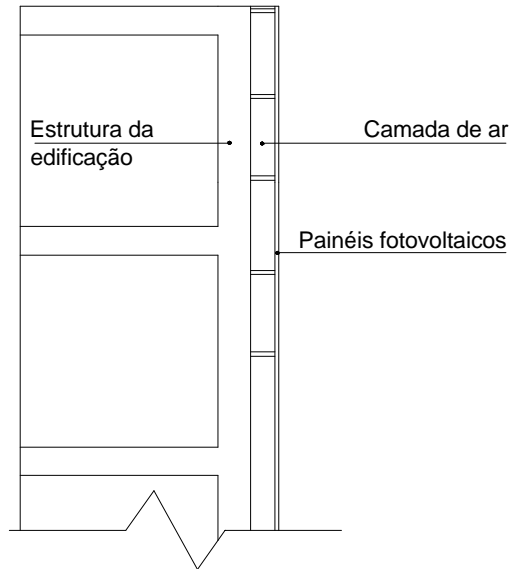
Corte esquemático dos painéis fotovoltaicos na fachada da edificação proposta.
